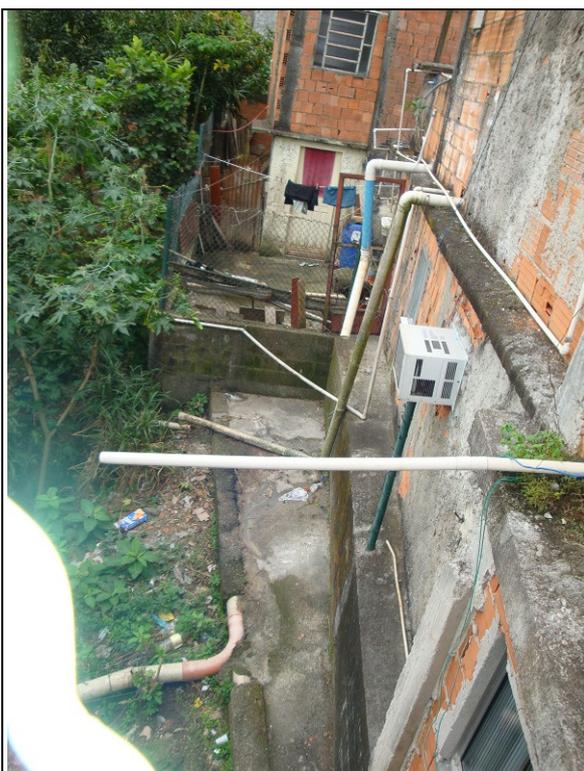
Muro de concreto/atrás do Cruzeiro – vertente voltada p/ Pedra Lisa
